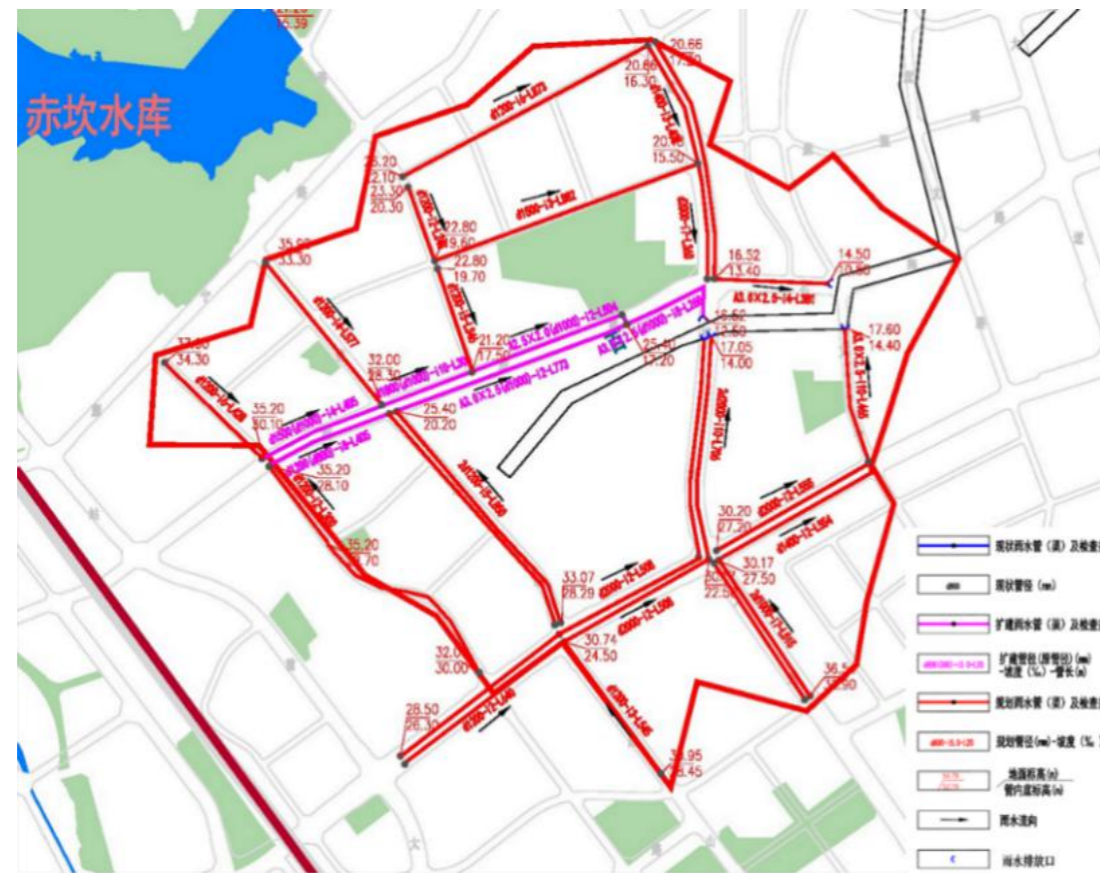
百姓渠上游分区远期新、改扩建雨水管渠平面图
